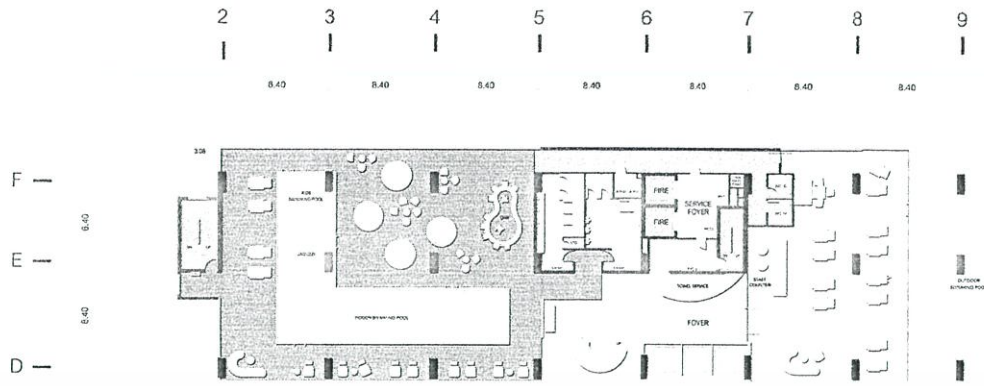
แสดง 5<sup>th</sup> FLOOR PLAN
